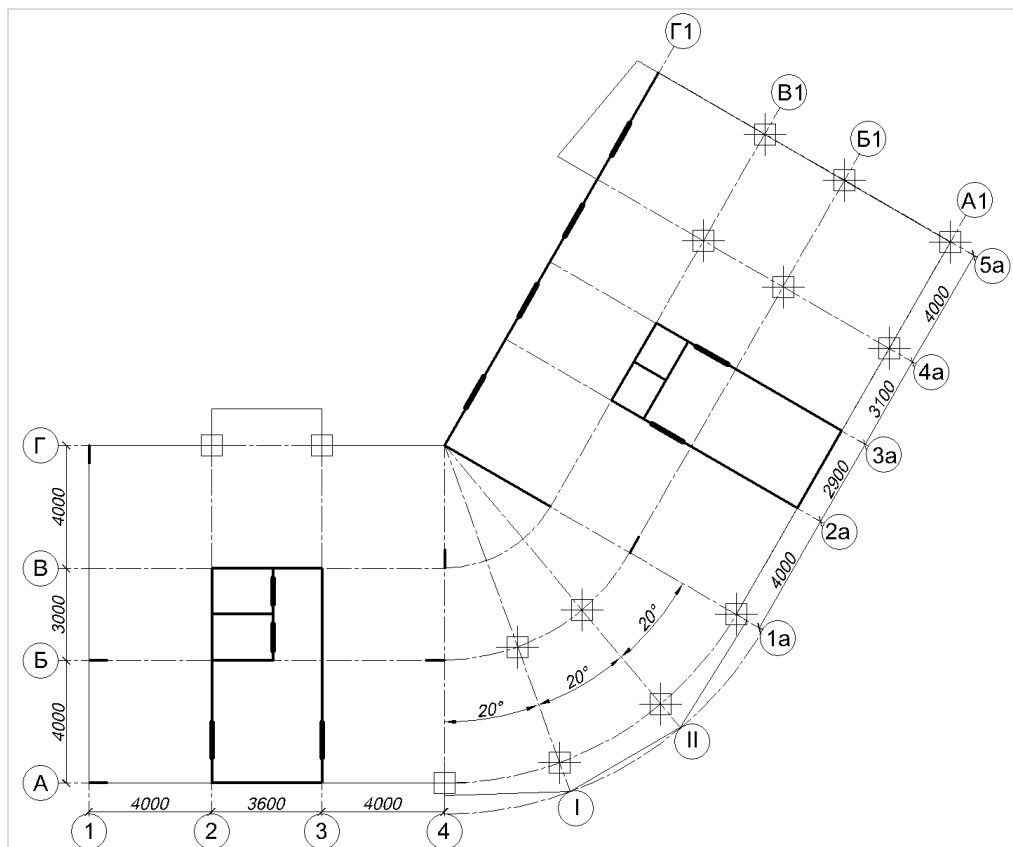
Плита перекрытия типового этажа (после корректировки)
